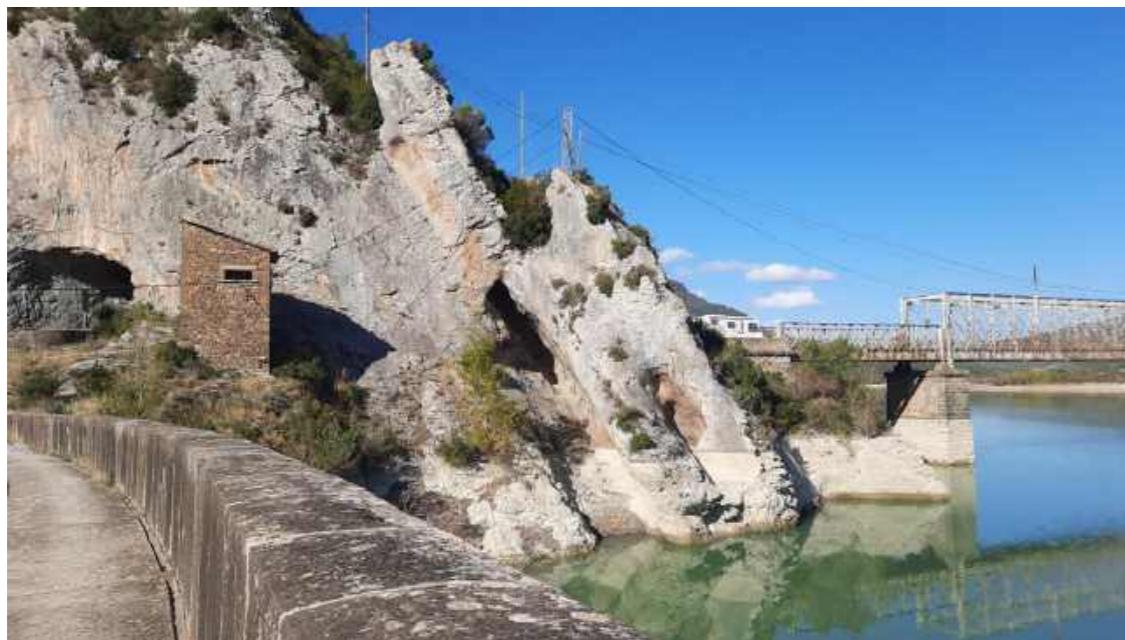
Punto 9. Puente actual desde la presa y escarpe rocoso sobre el que se construirá el vial de acceso y estribo sur del futuro puente.
